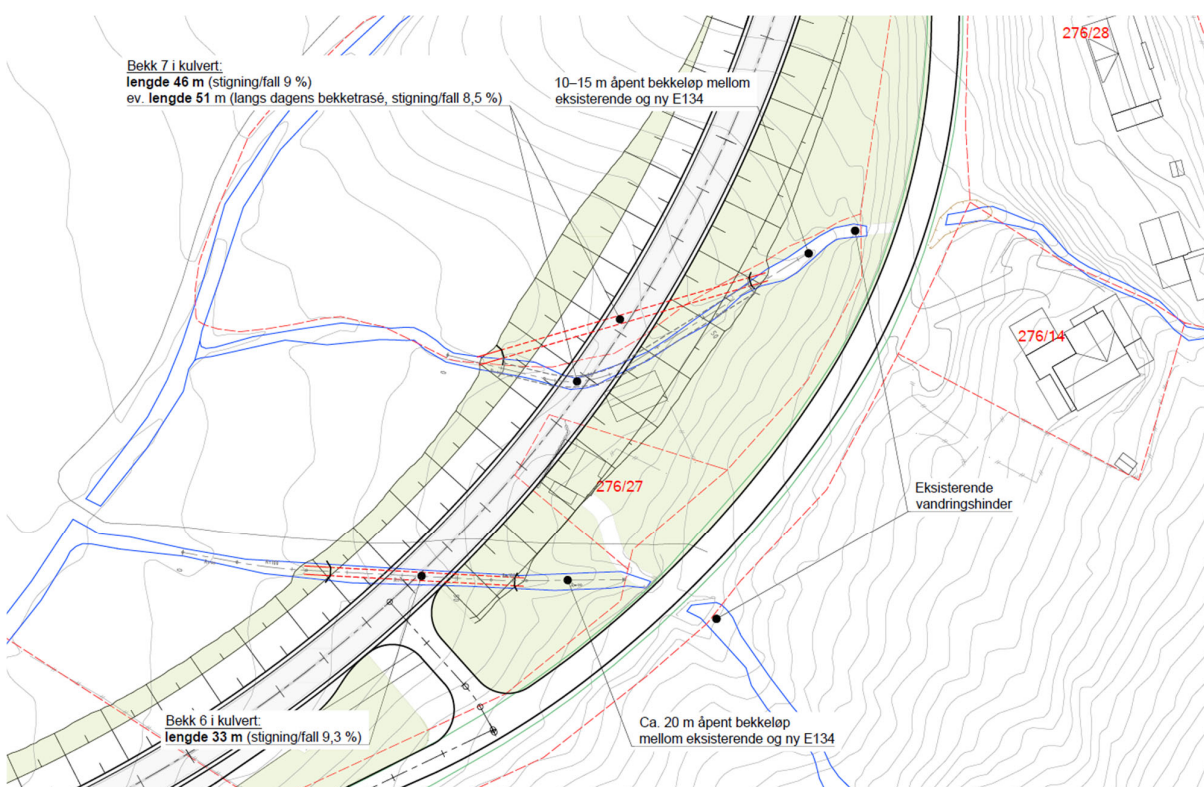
Bekkestrekning mellom oppstrøms ende av planlagt kulvert og vandringshinder.
